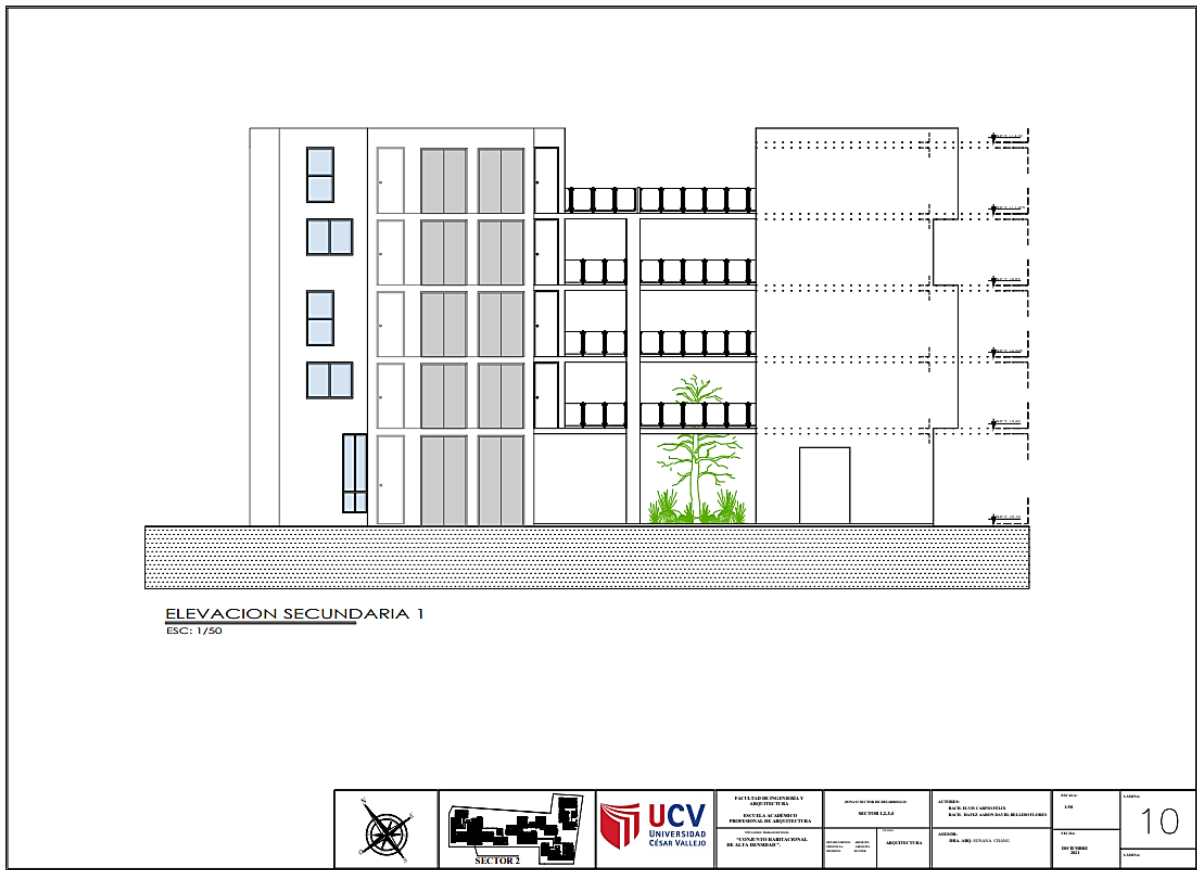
Planos de Arquitectura – 10 - Bloque 2 – Elevaciones – Elevación Secundaria
